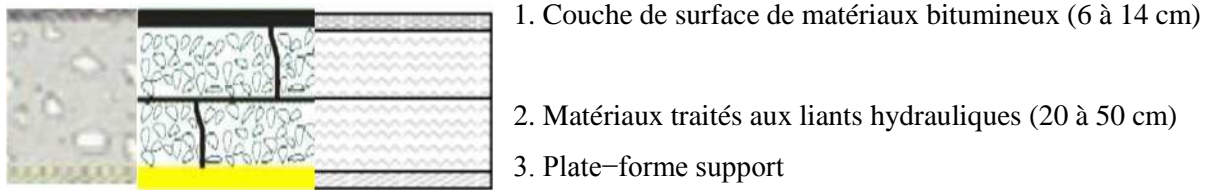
Chaussées à assise traitée aux liants hydrauliques [4]
